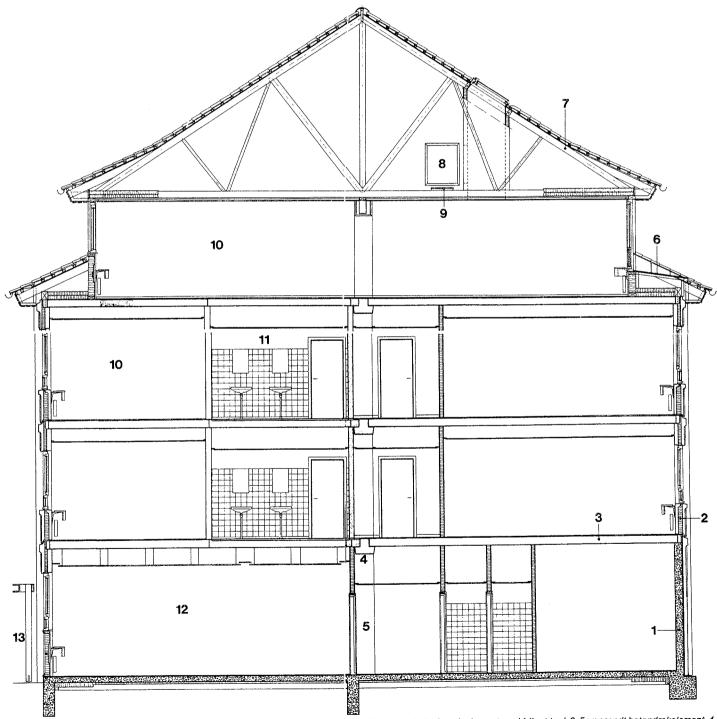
Lodret tværsnit. Mål: 1:100. 1. Pladsstøbt kældervæg under terræn mod øst. 2. Betonsandwichfacadeelement med frilagt tegl. 3. Forspændt betondækelement. 4. Forspændt betondrager. 5. Betonsøjle. 6. Platform til brandredning i etage 4. 7. 30° trægitterspærfag med skalk, tagdækning af røde vingetegl. 8. BS 60 lem i brandsektionsvæg. 9. Gangbro. 10. Kontorer. 11. Toiletgruppe. 12. Kantine. 13. Udvendige pergola.
